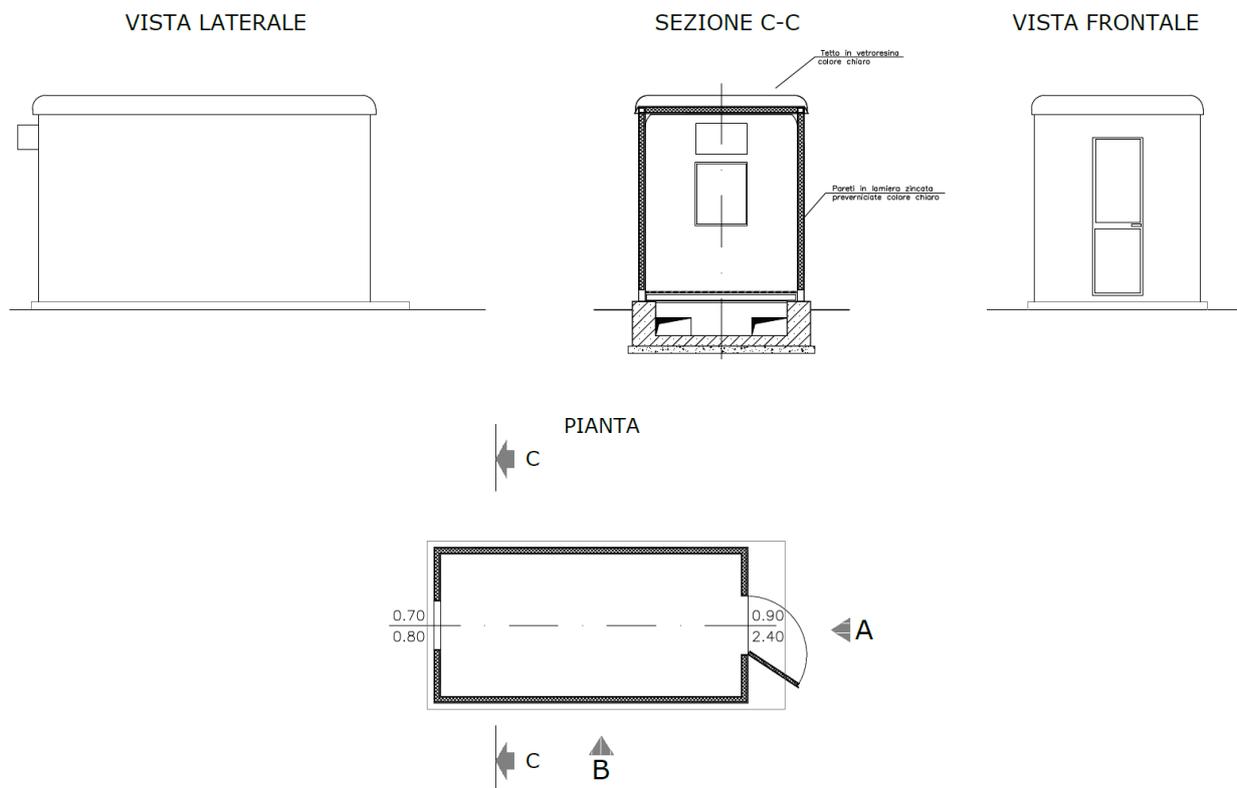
Pianta e prospetti dei chioschi per apparecchiature elettriche.
